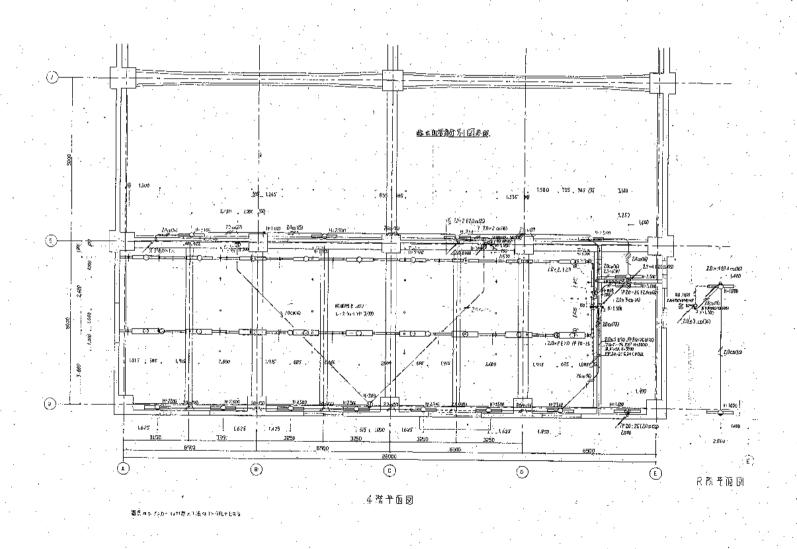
汚泥濃縮棟 3 階上部平面図 1 図番 1 1
